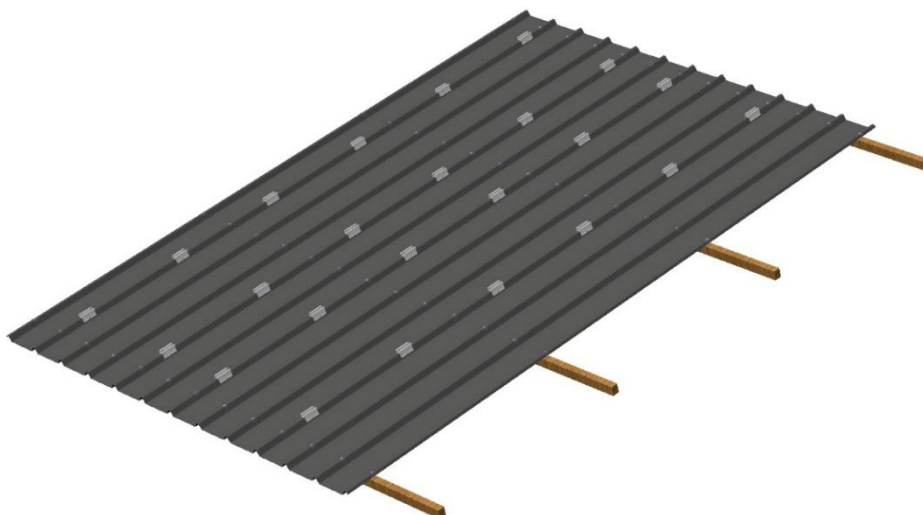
Vue d'ensemble des rails ISY-STEEL sur toiture en bac nervuré
